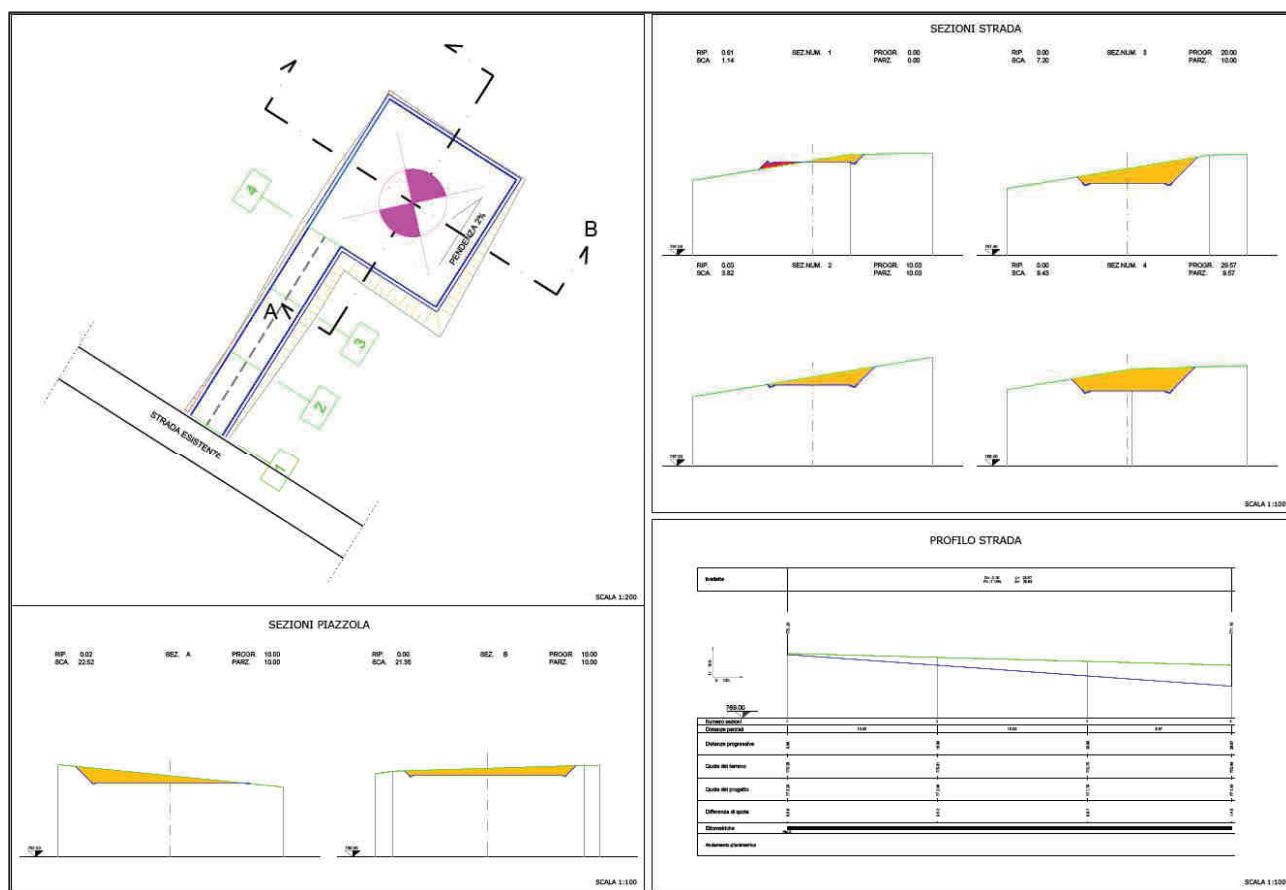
Pianta, sezioni e profilo strada e piazzola CS01 (fase di esercizio) con scavi (arancione) e riporti (rosso).
